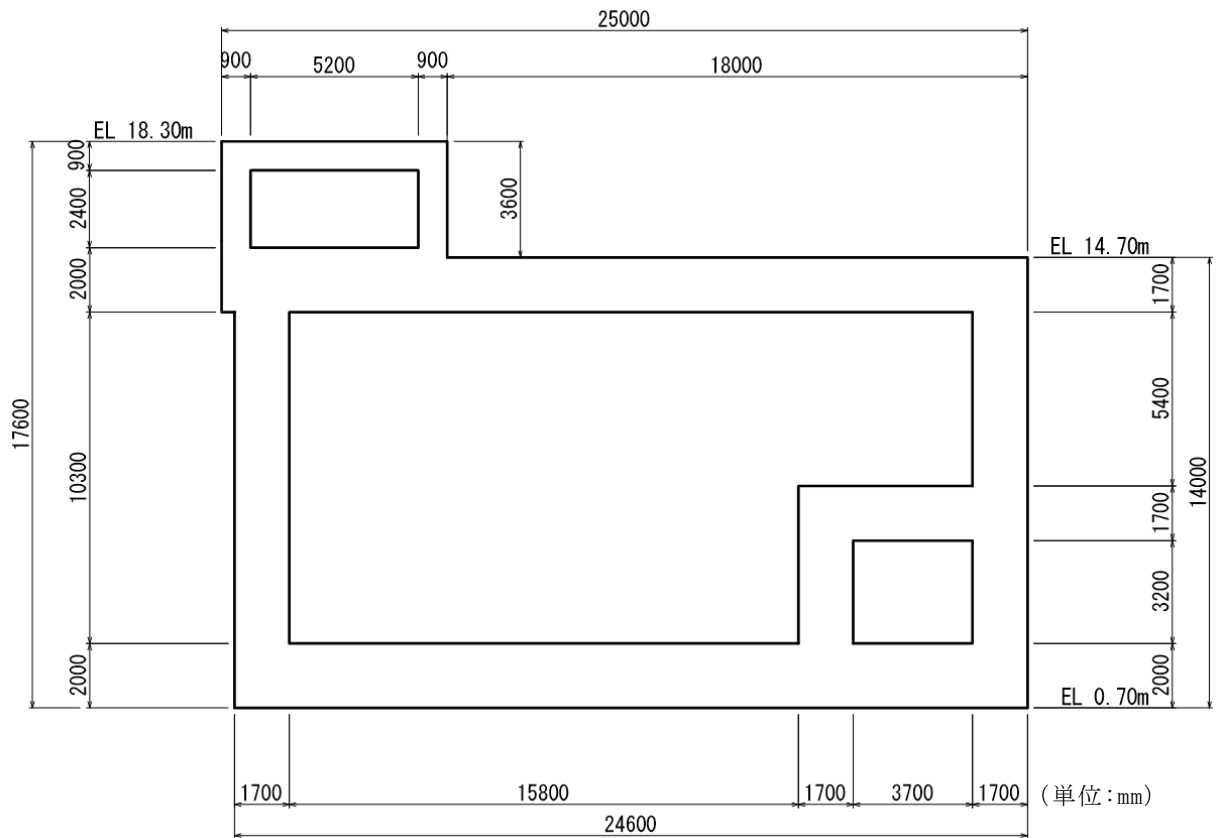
第 1 ベントフィルタ格納槽 断面図 (C-C 断面)
